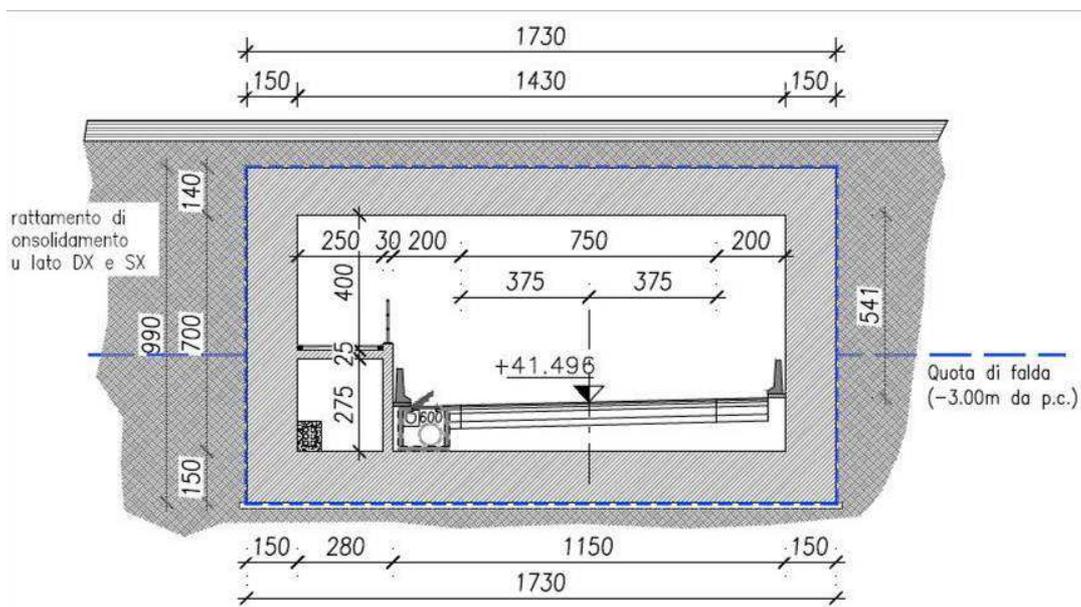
SEZIONE TRASVERSALE SOTTOVIA "RETE 2" (ESTRATTO DALL'ELABORATO T00ST01STRSZ01A)
